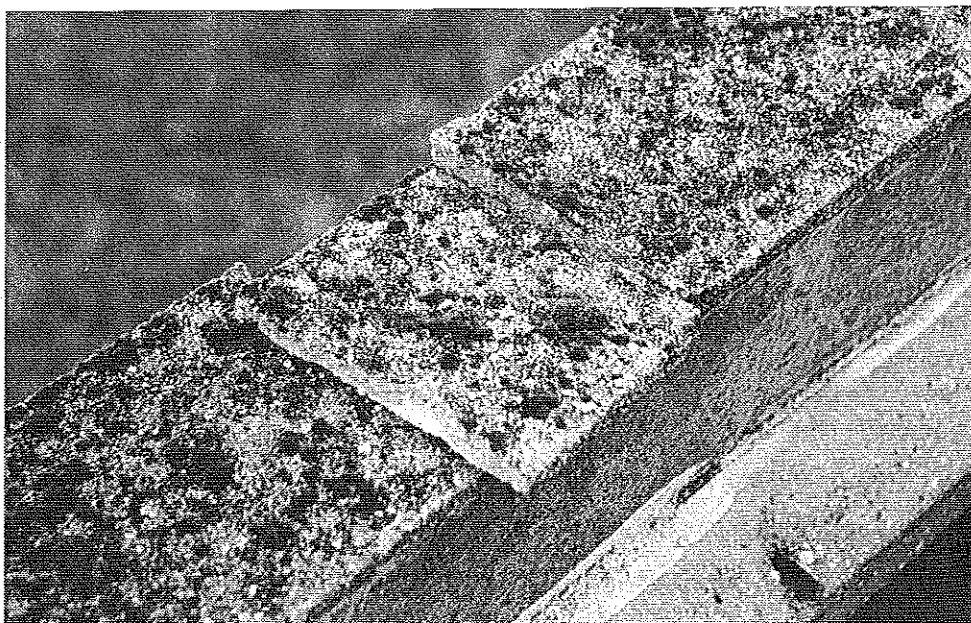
Fissuration de l'enduit appliqué sur le dessus d'acrotère avec décollement et chute d'éléments. © J. Putatti
